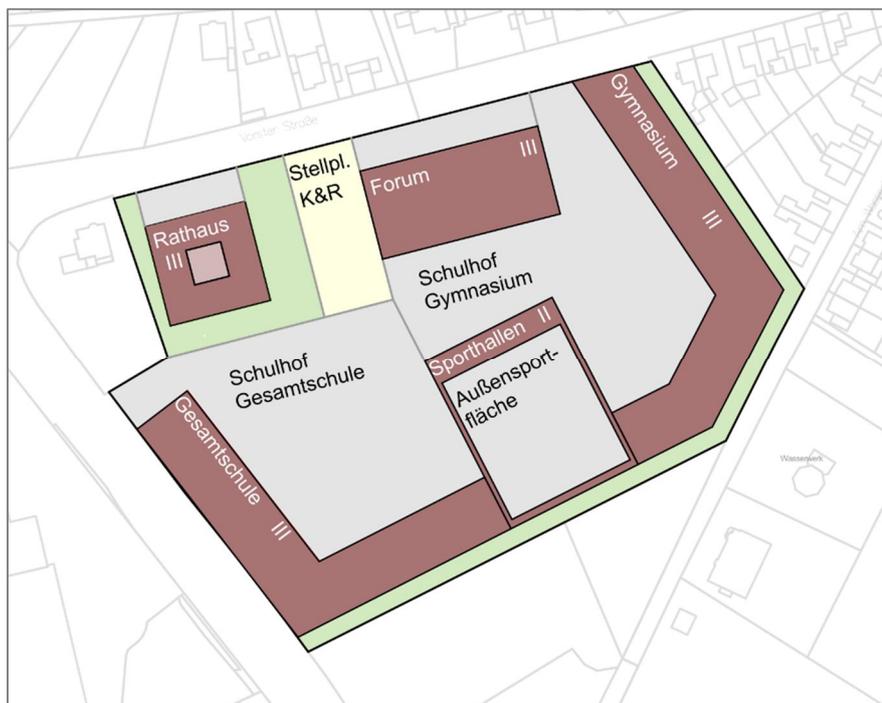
Layoutplanung Variante 1 „Am Wasserturm“ (Quelle: assmann GmbH)
